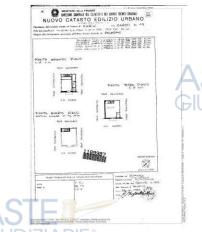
PLANIMETRIA CATASTALE - ANNO DICHIARAZIONE - 1993
